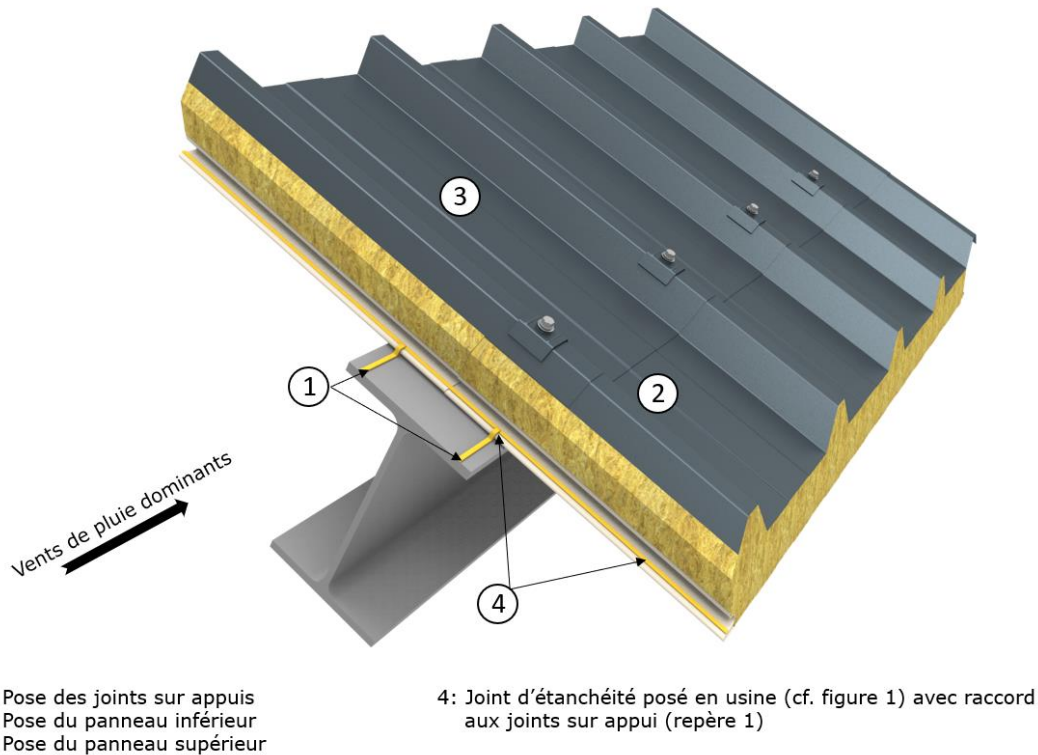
Détail sur appui – Joints sur appuis au droit d'un recouvrement transversal de panneaux avec complément d'étanchéité (C.E.) transversal et longitudinal – locaux climatisés (cf. §2.4.4.1)
